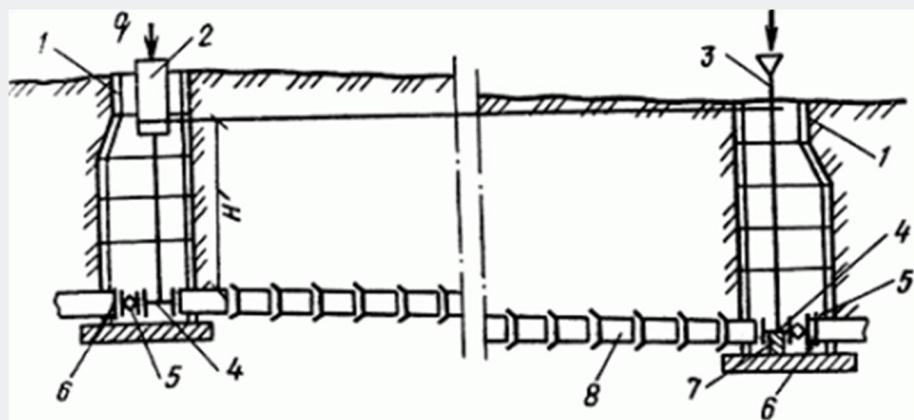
Схемы приемочного испытания безнапорного трубопровода с колодцем без гидроизоляции
